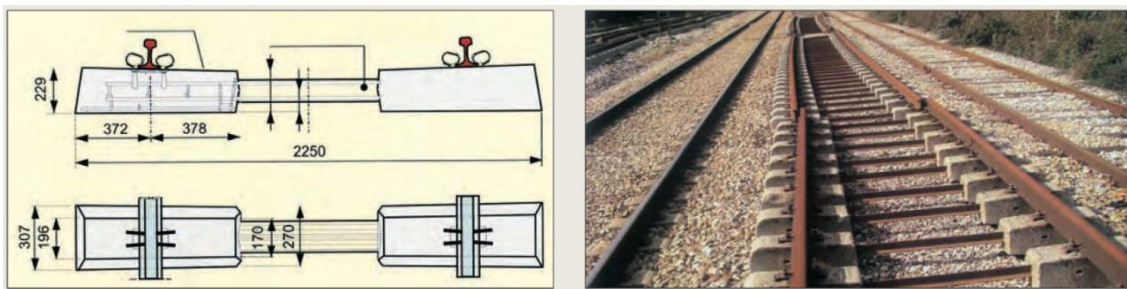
Traviesa de hormigón armado bibloque. [1]
